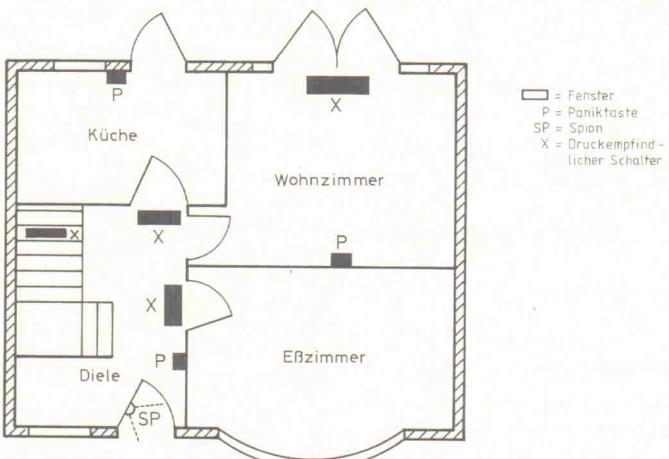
Grundriß des Erdgeschoßes eines zweistöckigen Hauses mittlerer Größe mit minimaler Ausstattung von Punktschutz und Paniktasten.
